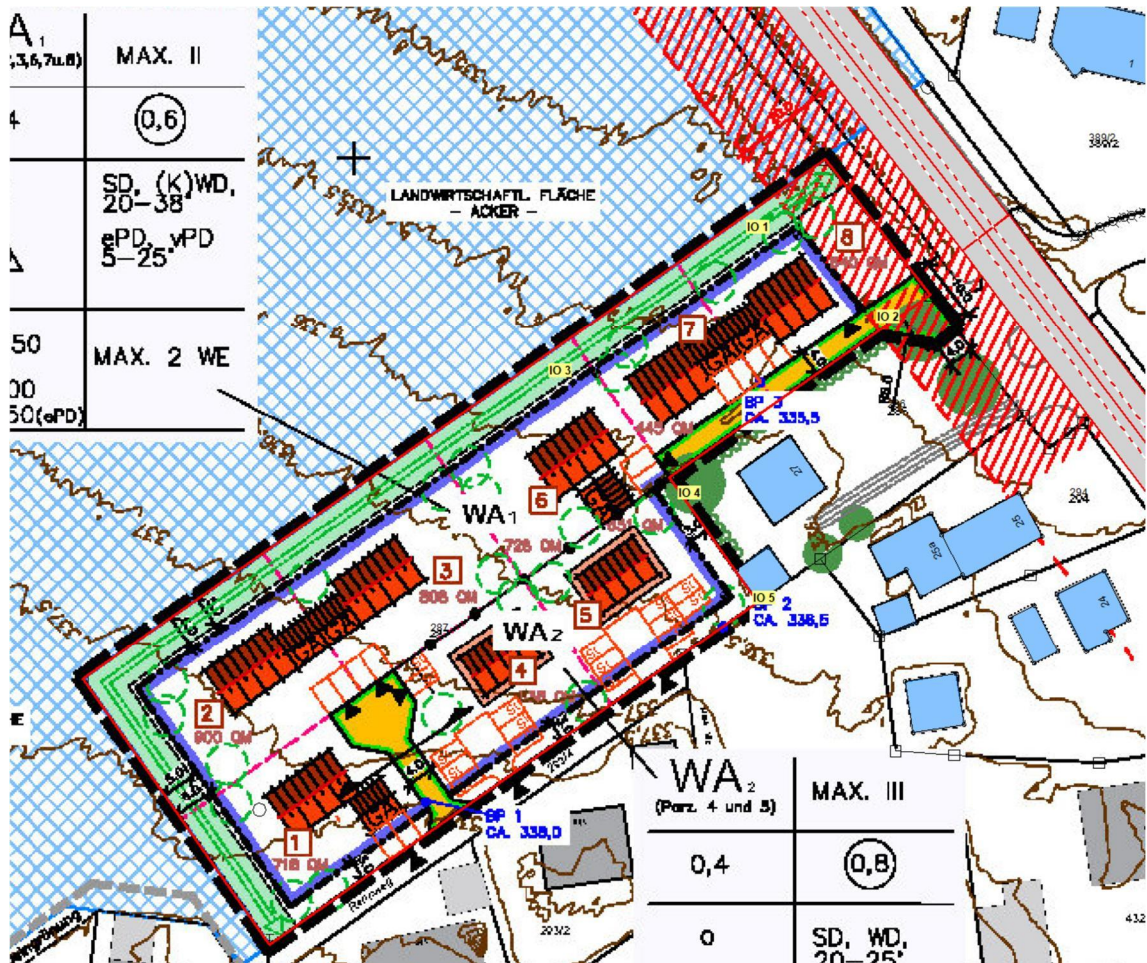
Lageplan mit Kennzeichnung der Immissionsorte IO 1 – IO 5
